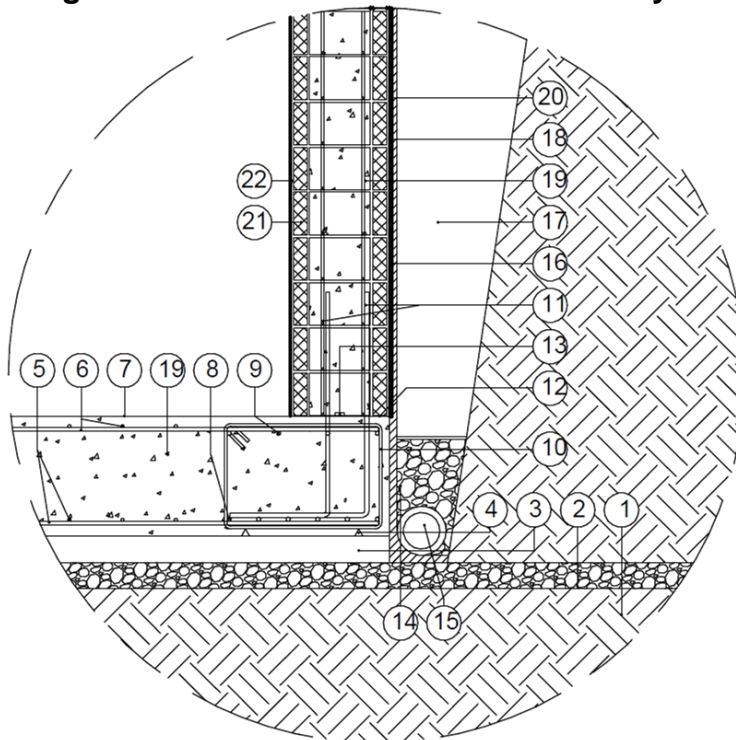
Encuentro de muro sótano S35\_4Np\_4Np con forjado y muro sismo S25\_4Np\_4Np
